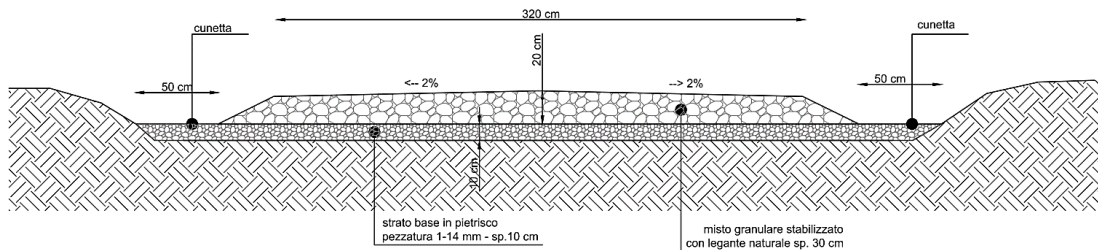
Sezione tipo strada di collegamento impianto/viabilità pubblica (Fonte: ns elaborazione)
